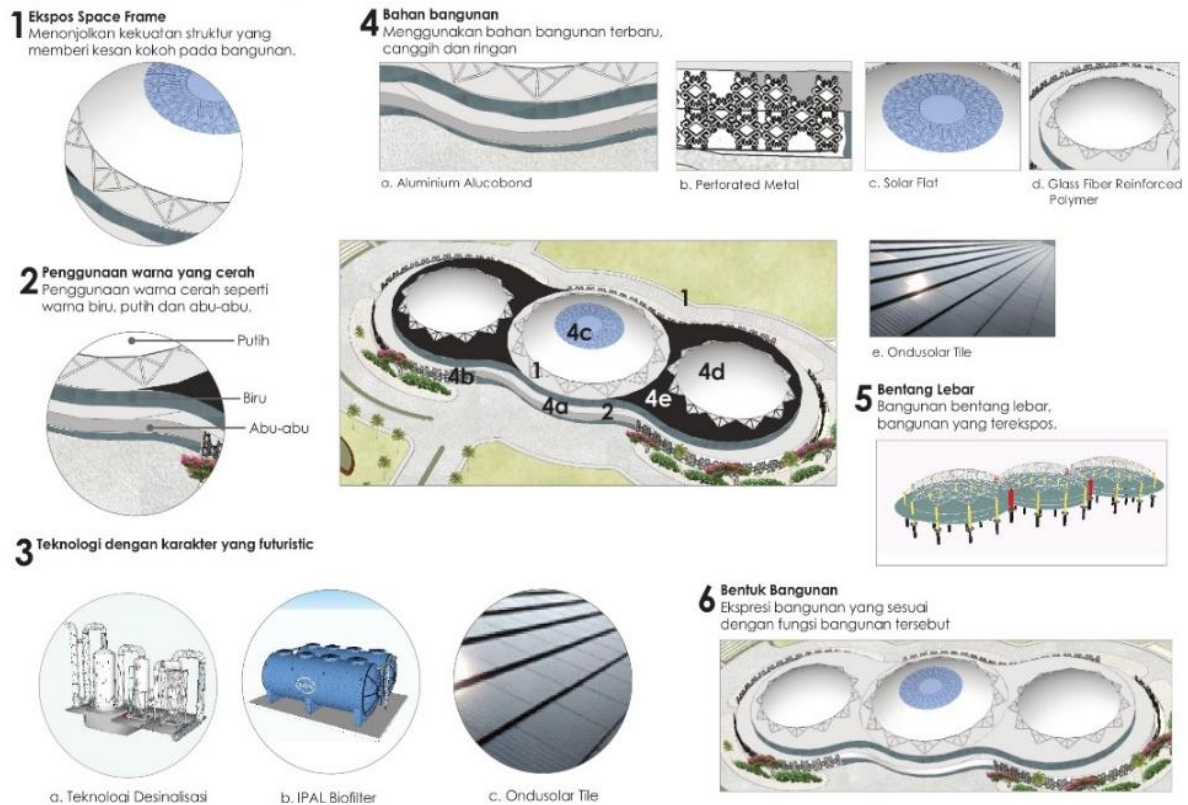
Penerapan Struktur Pada Bangunan Aquatic Center
